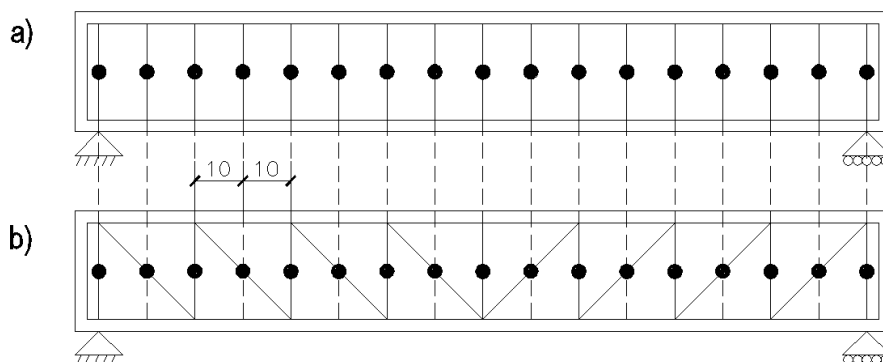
(a) Vigas com estribos verticais; (b) Vigas com estribos verticais e inclinados alternadamente
